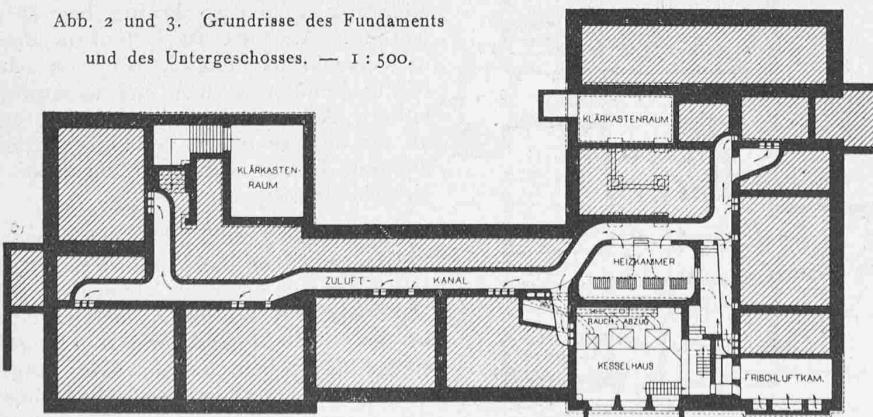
und 3. Grundrisse des Fundaments
